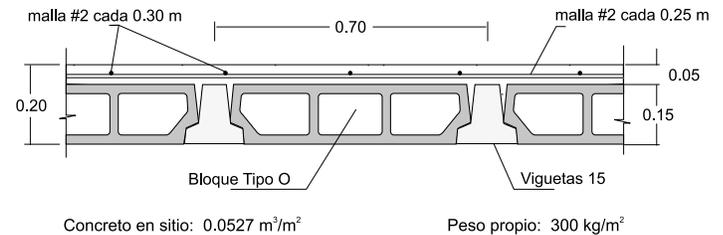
Detalle típico de entrepiso de vigueta de 15 cm con bloque tipo O
